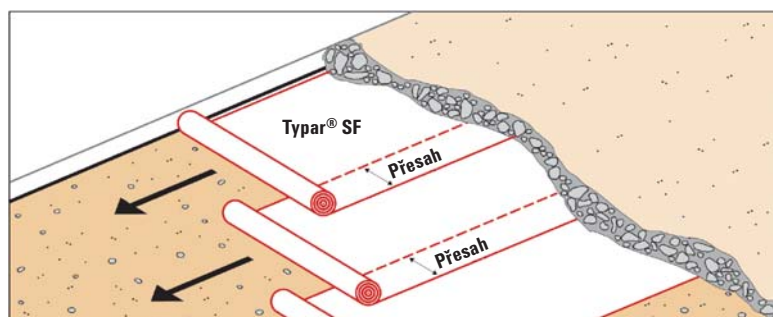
Uzavření kameniva Typar® SF s přesahem minimálně 30 cm
